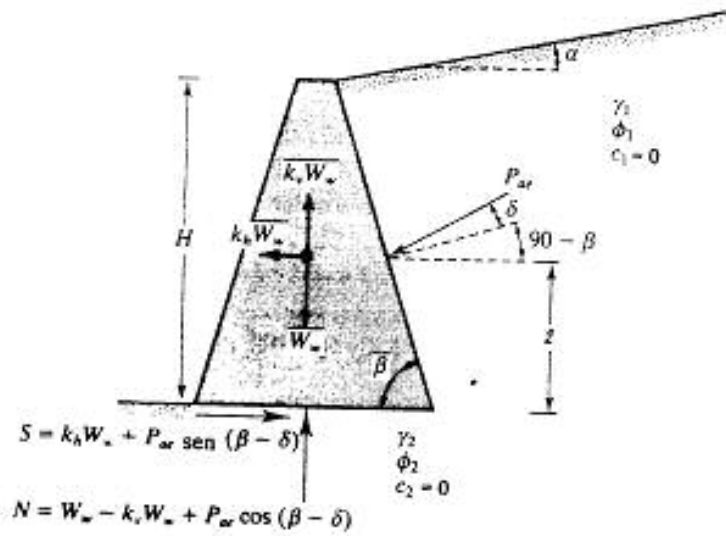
Estabilidad de un muro de retención bajo fuerzas sísmicas
